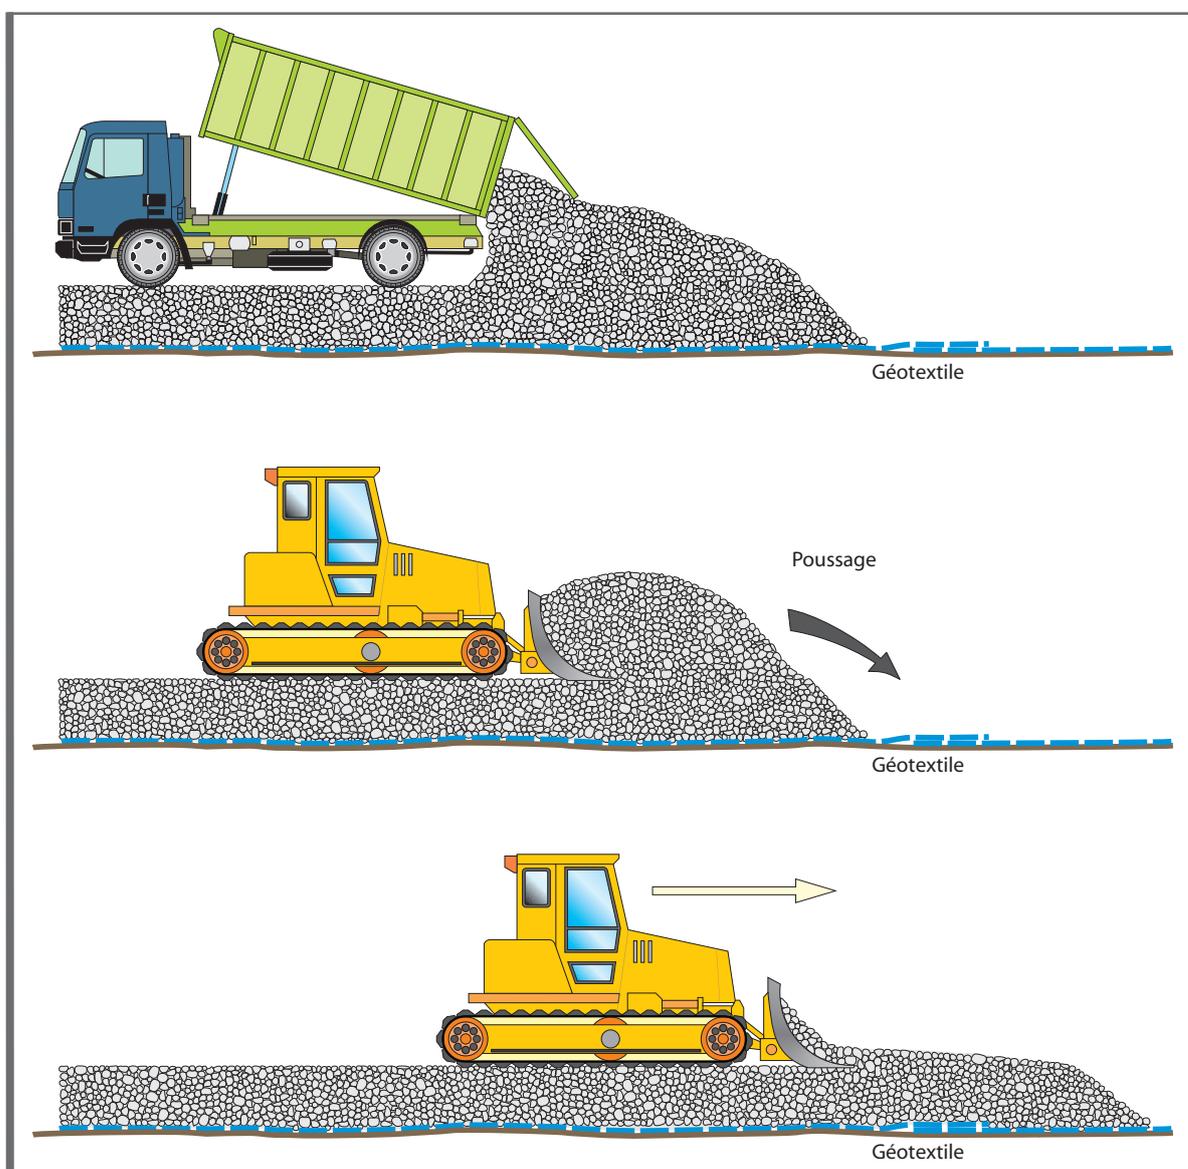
Mise en œuvre de l'empierrement sur un géotextile
